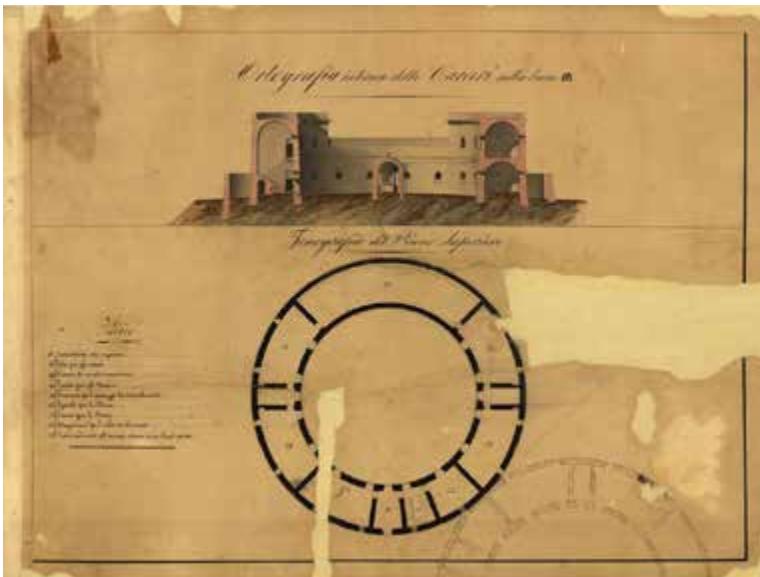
Enrico Marchesi, progetto del carcere La Rotonda a Nuoro, 1838, pianta del piano superiore e sezione, penna, inchiostro nero e acquerello. 1838. ASC, Tipi e Profili, TP103-004.
